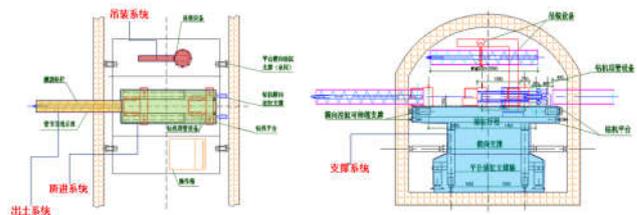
洞内管幕施做专用工装平面图 图2-2 洞内管幕施做专用工装横断面图
